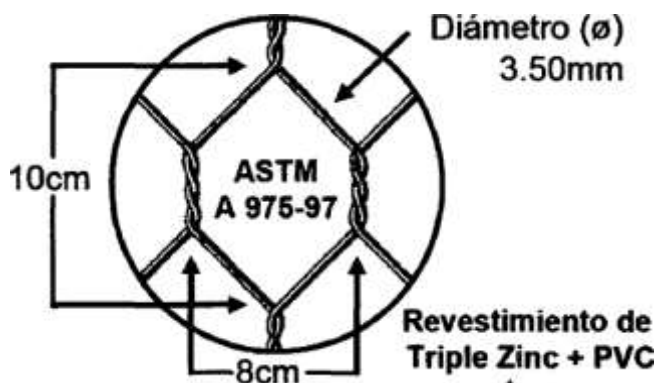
Gavión tipo caja o colchón antisocavante plastificado
